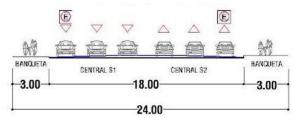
Sección de tramo vial 342. Fuente: Anexo de Secciones Viales del PDU 2040.
